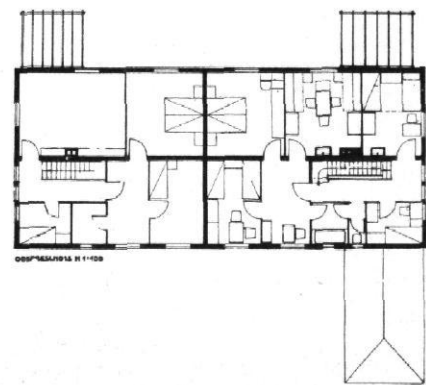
bis 73 / Breslau / Ausstellung Doppelhaus / Architekt: Gustav Wolf / Mitte: Blick in das Treppenhaus / Unten: Grundrisse 1 : 400 und Blick in das Esszimmer. Dieser Raum ist im Grundriß achteckig, die Wände sind
